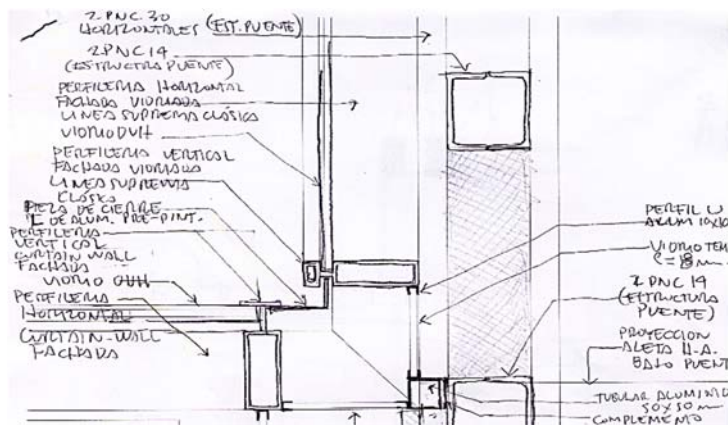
Anexo Torre Ejecutiva | Croquis constructivo: planta envolvente - estructura puente conector. Gráfico gentileza Arq. Javier Olascoaga.
